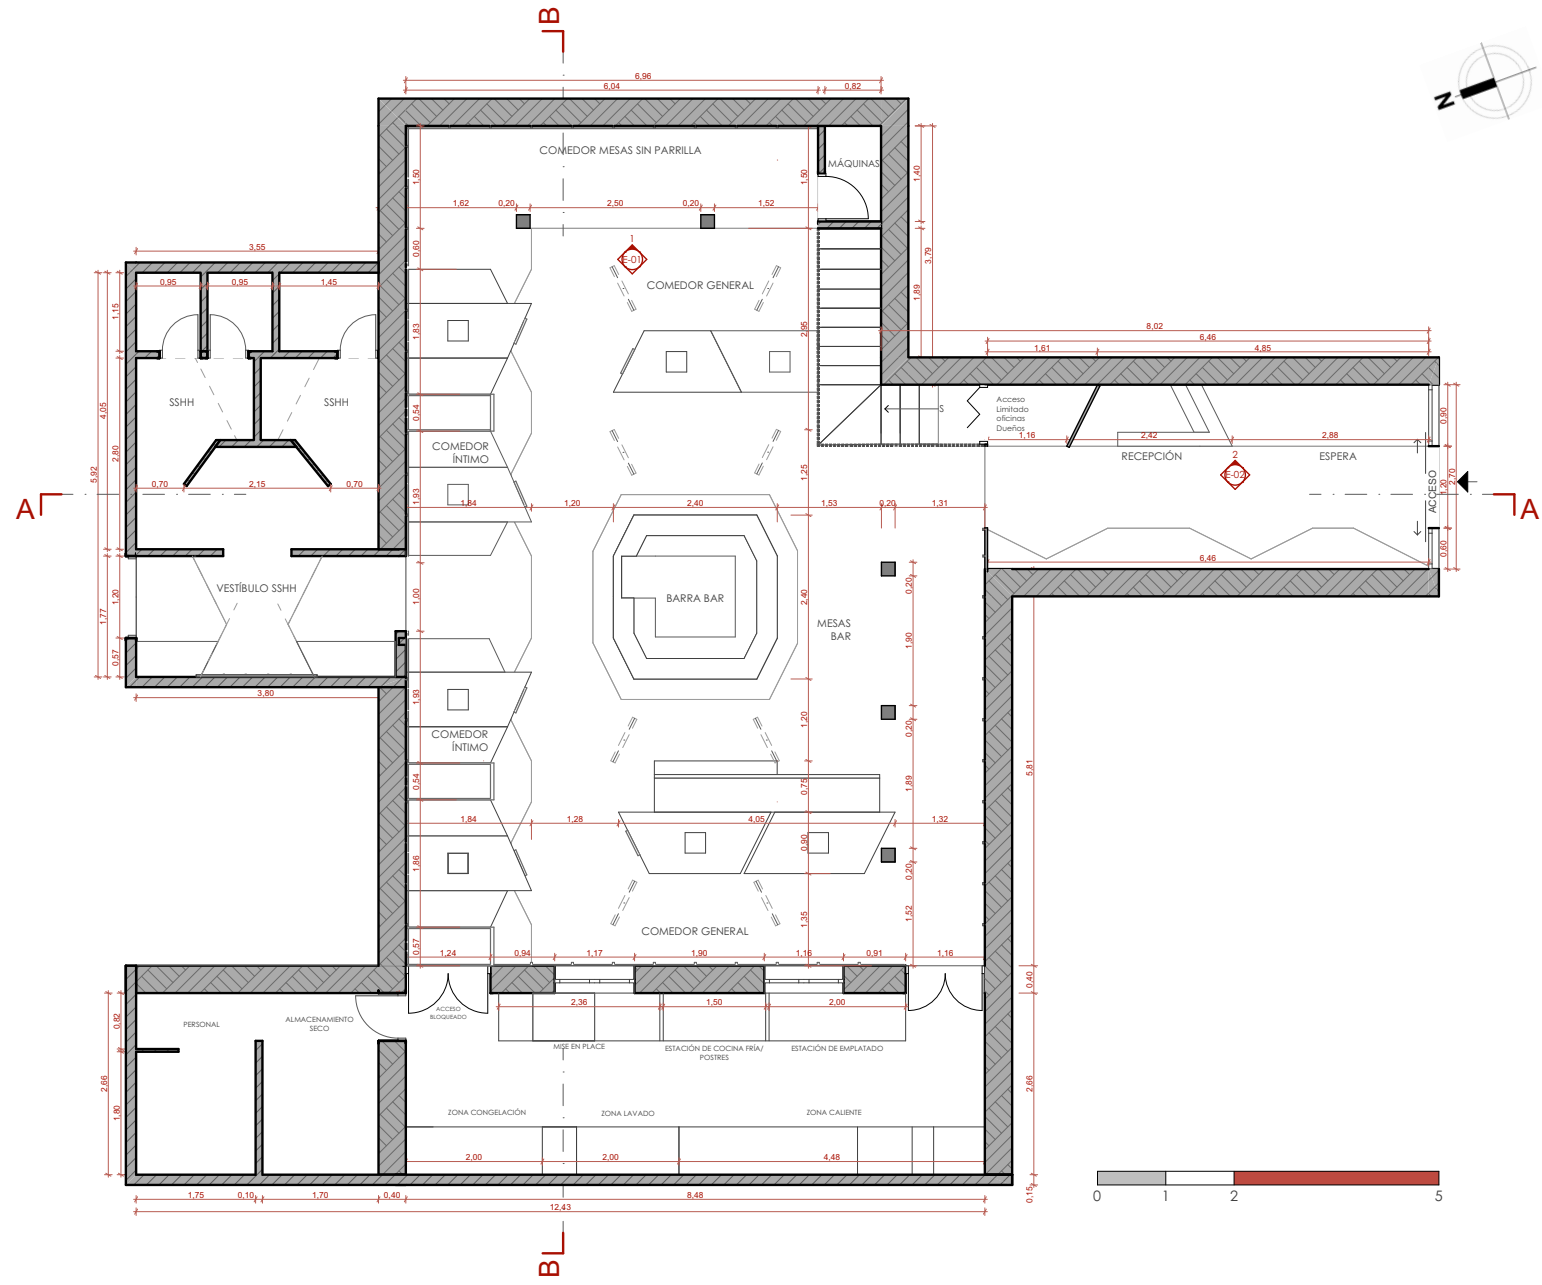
Planta de Distribución. Fuente: Elaboración Propia
